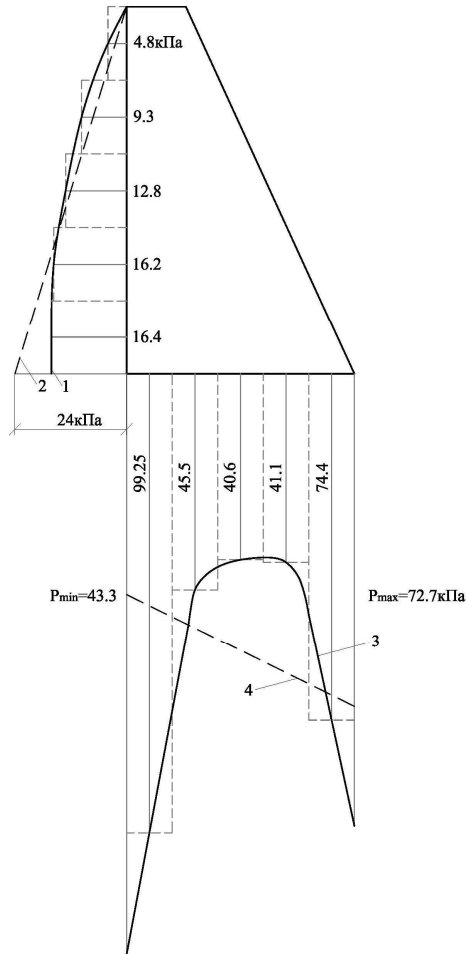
Эпюры давлений грунта на подпорную стенку при повороте ее вокруг верхней точки:
